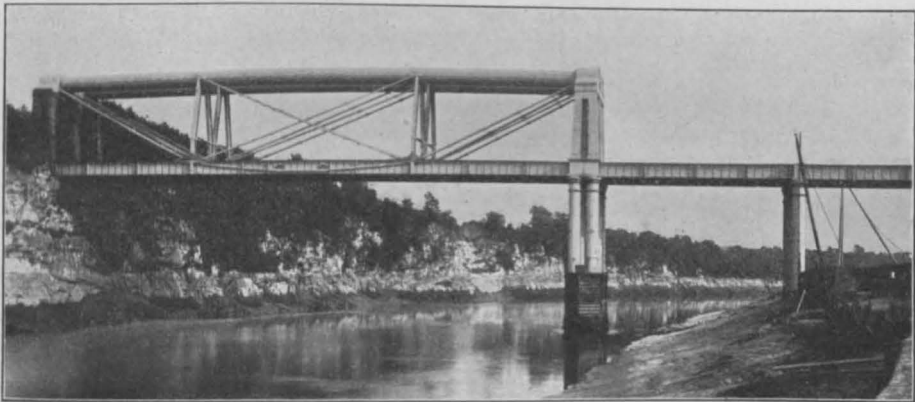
Eisenbahnbrücke über den Wyefluß bei Chepstow. J. BRUNEL. 1852.
